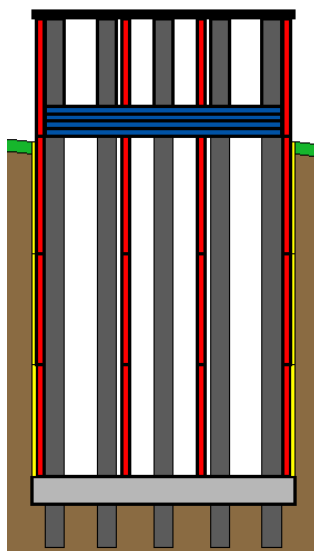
Бетонирование конструкций стен захватки 4 с выполнением постоянного закрепления к колоннам.
